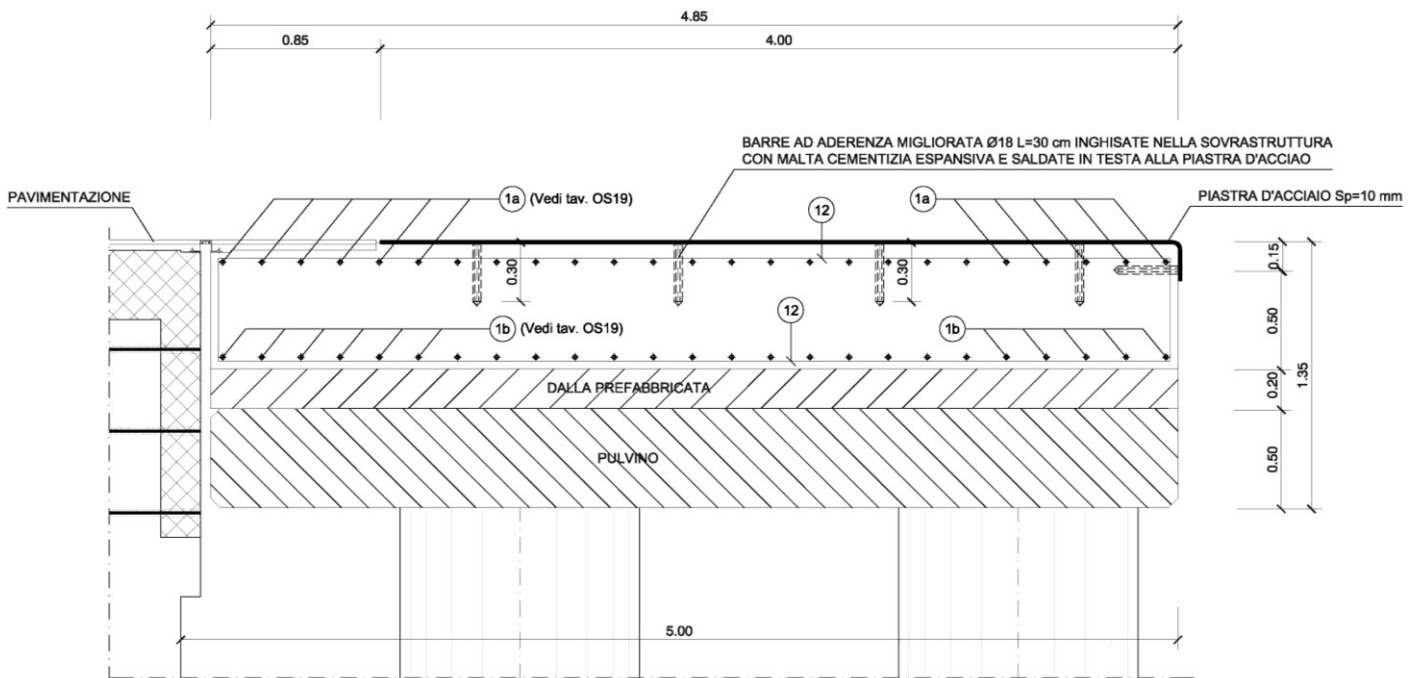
Banchina 12 – Sezione di progetto in corrispondenza della piastra (misure espresse in metri)
